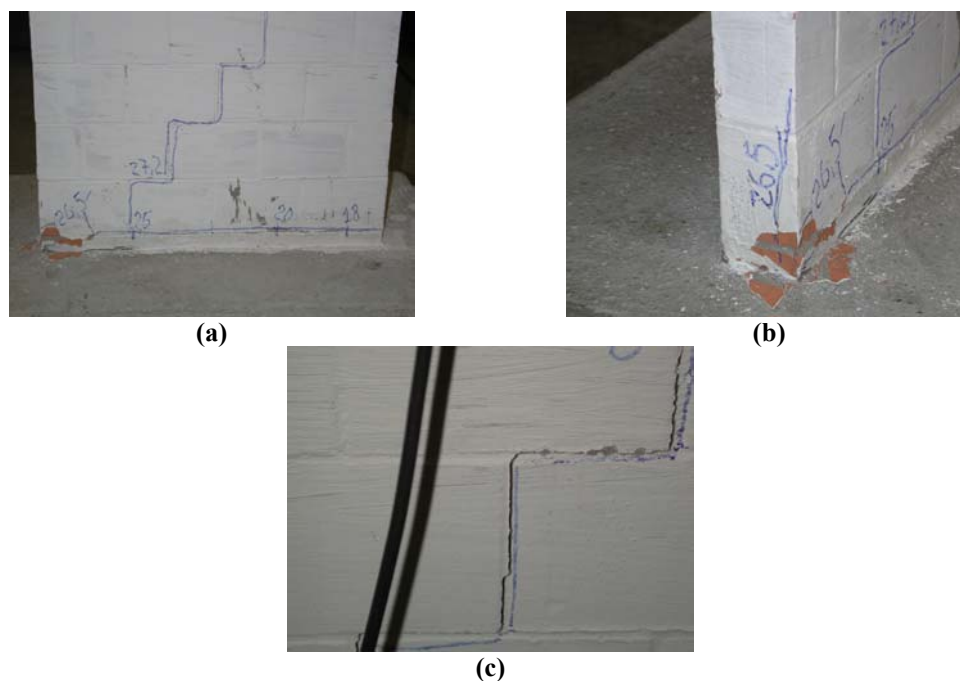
Base da parede P2 do modelo PPSG1: (a) Prolongamento da fissura horizontal e fissuração diagonal; (b) Detalhe do esmagamento no canto comprimido; (c) Detalhe da fissura diagonal.
